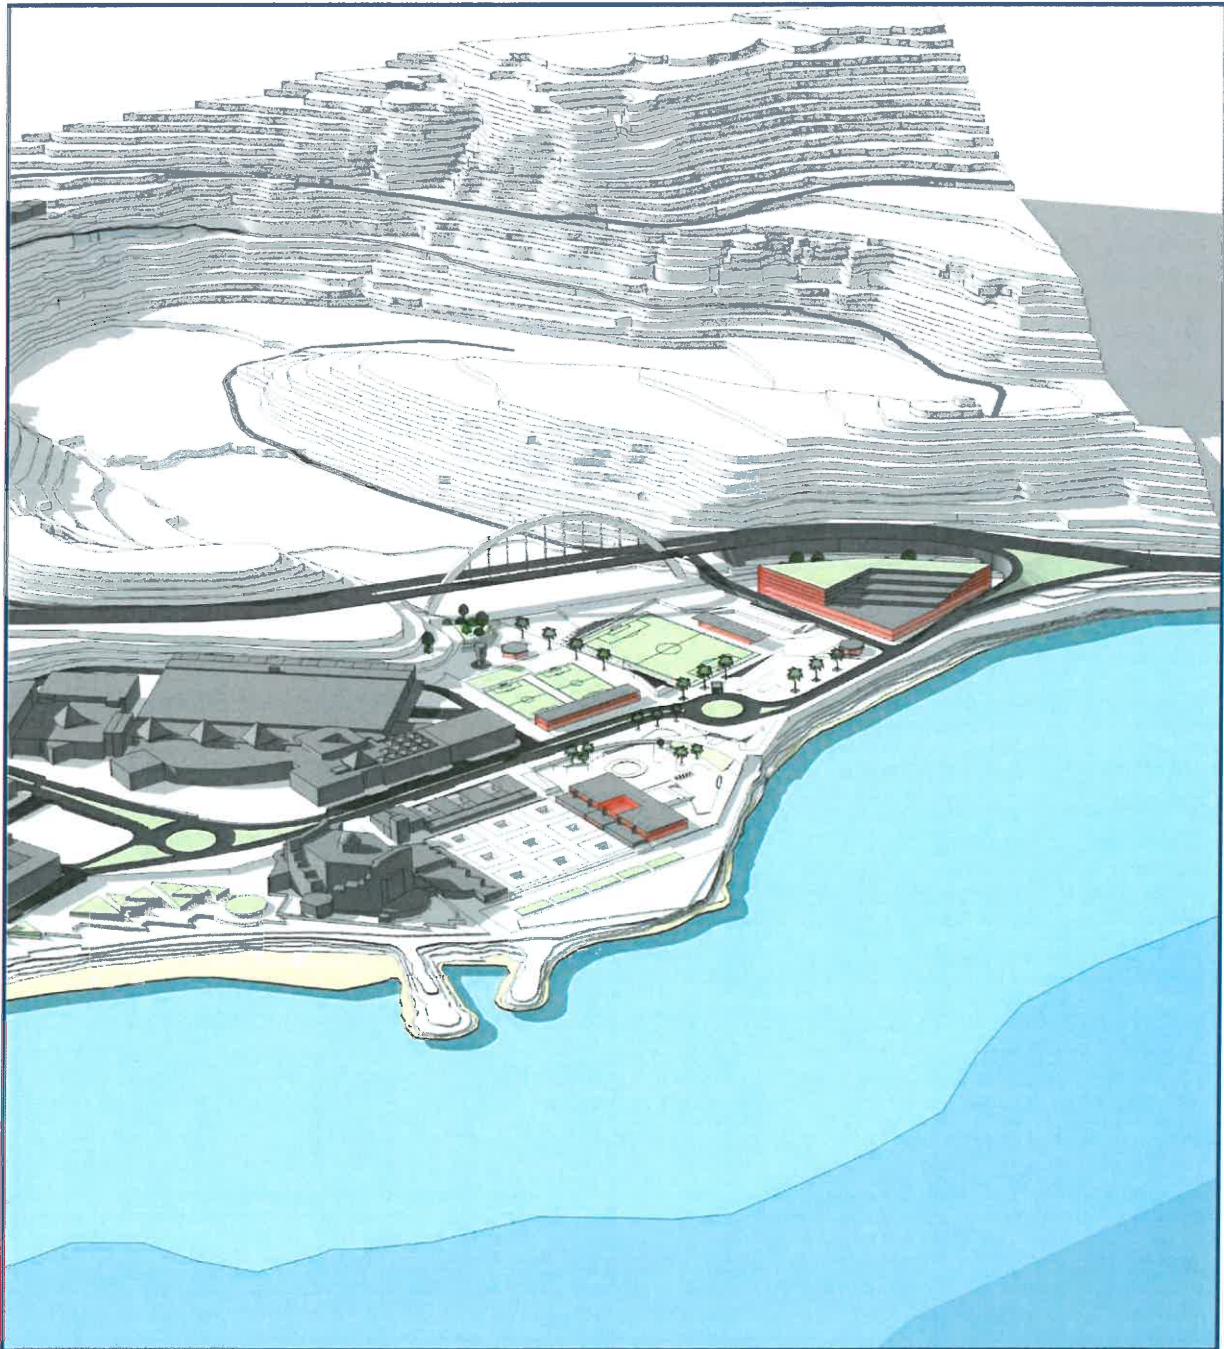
Alternativa 2. Imagen de la volumetría 1. Fuente: elaboración propia
